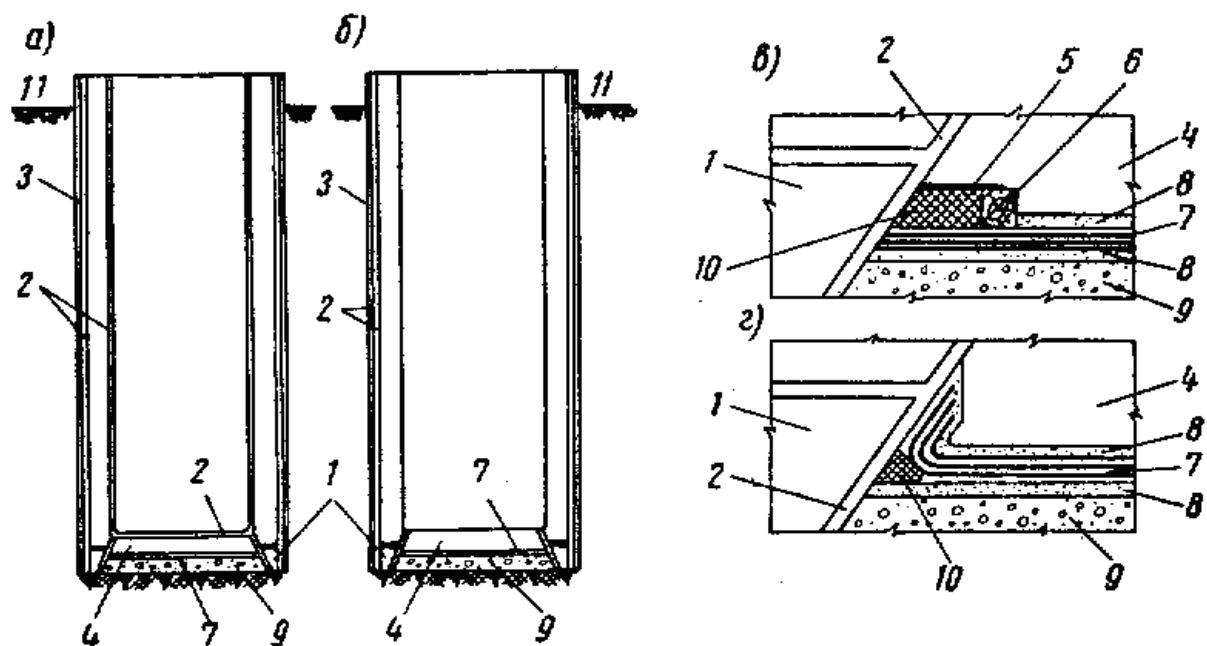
Гидроизоляция опускных колодцев: а – с двух сторон; б – с одной наружной стороны; в, г – сопряжения оклеечной гидроизоляции с цементной гидроизоляцией стен; 1 – нож опускного колодца; 2 – цементная гидроизоляция (торкрет); 3 – окрасочная битумная гидроизоляция; 4 – днище опускного колодца; 5 – лист оклеечной гидроизоляции; 6 – деревянная рейка 50x50мм; 7 – оклеечная гидроизоляция; 8 – выравнивающая и защитная стяжки; 9 – бетонная подготовка; 10 – битумная мастика; 11 – уровень земли
